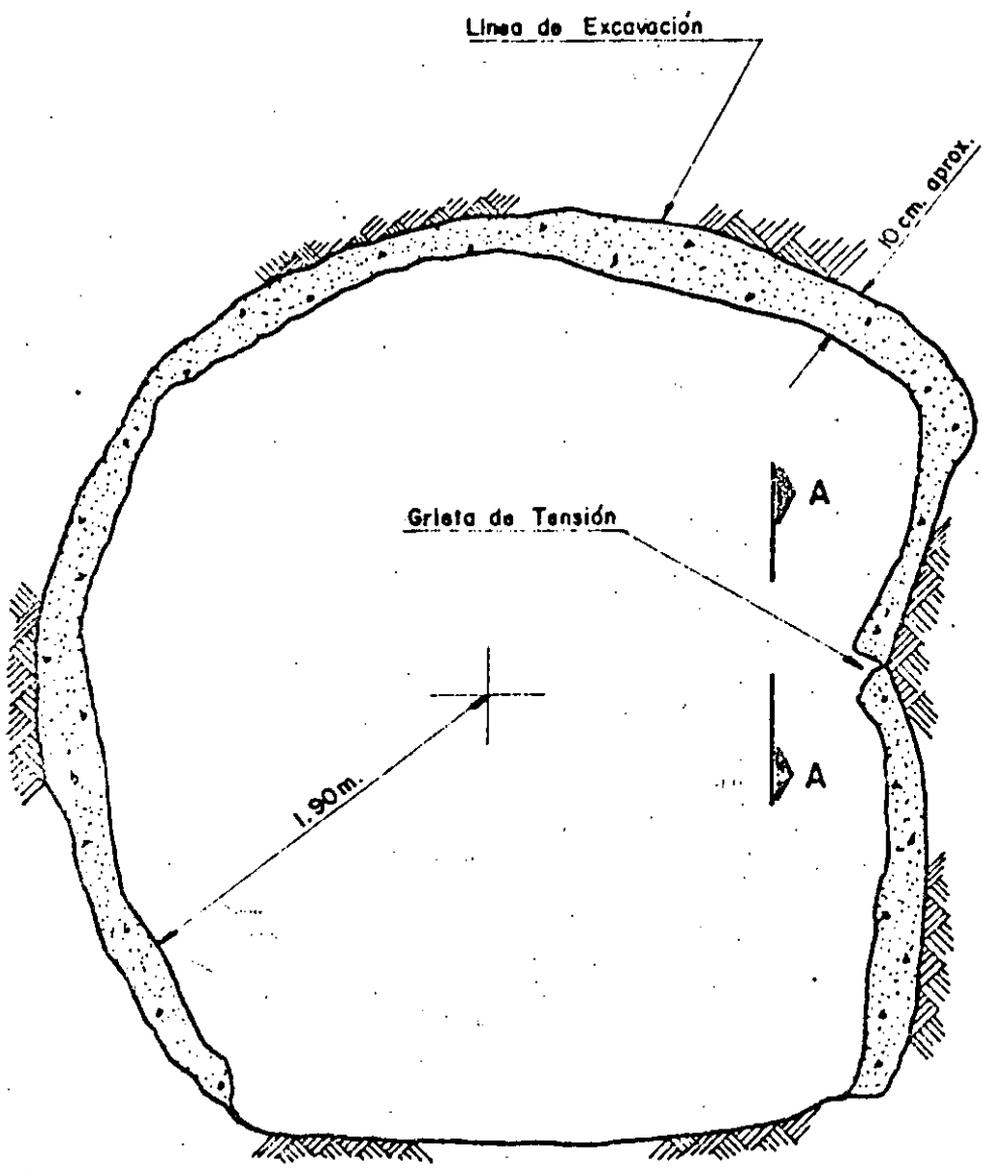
DESARROLLO DE GRIETAS DE TENSION EN UNA PROTUBERANCIA DE LA ROCA
